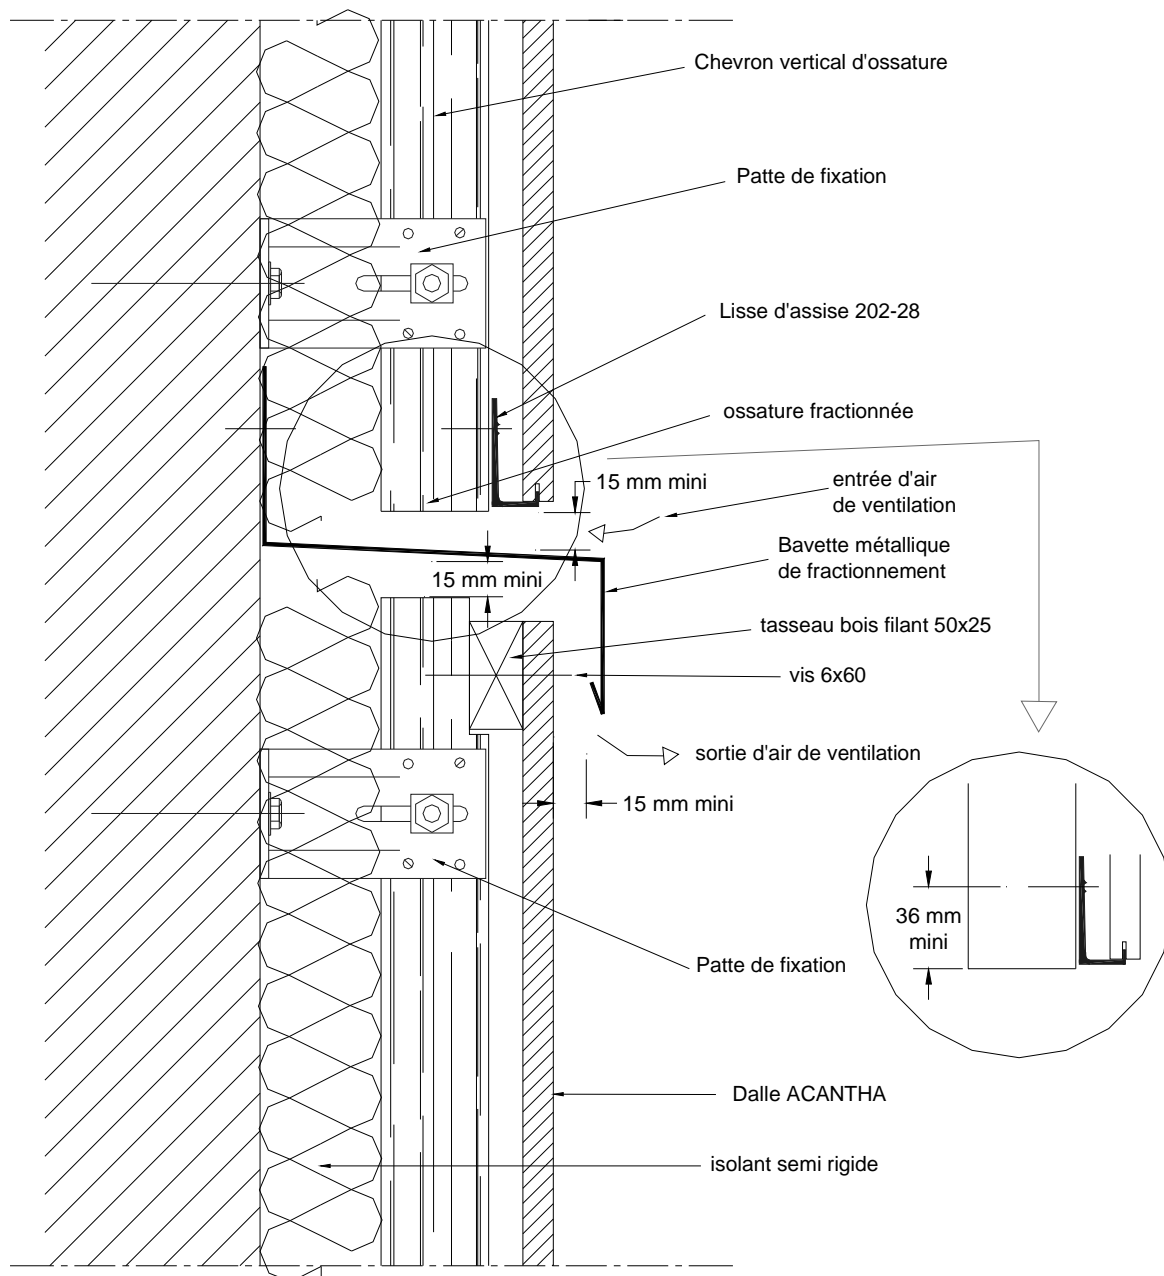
Joint horizontal de fractionnement de l'ossature (tous les 4 niveaux ou 12 m (h))
